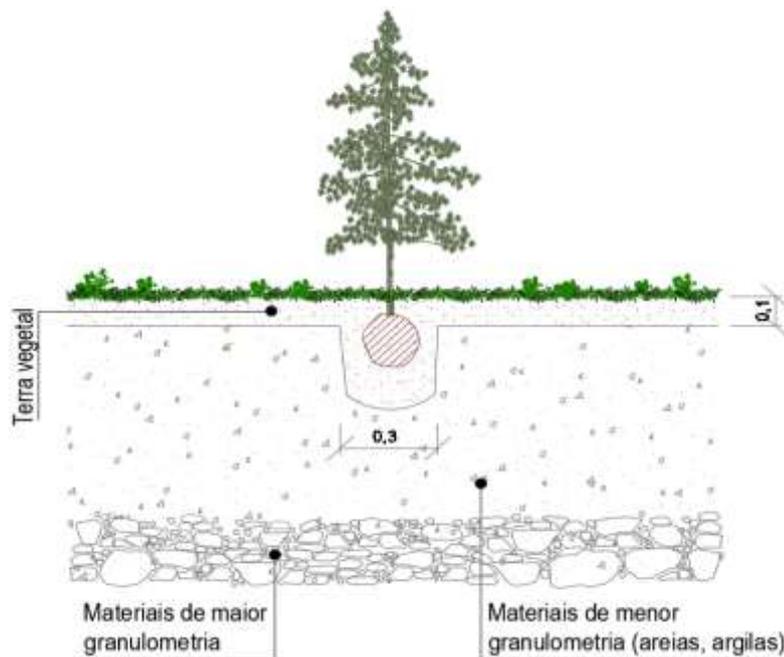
Desenho esquemático da metodologia de plantação, camada e bolsas de terra vegetal para as plantações.
